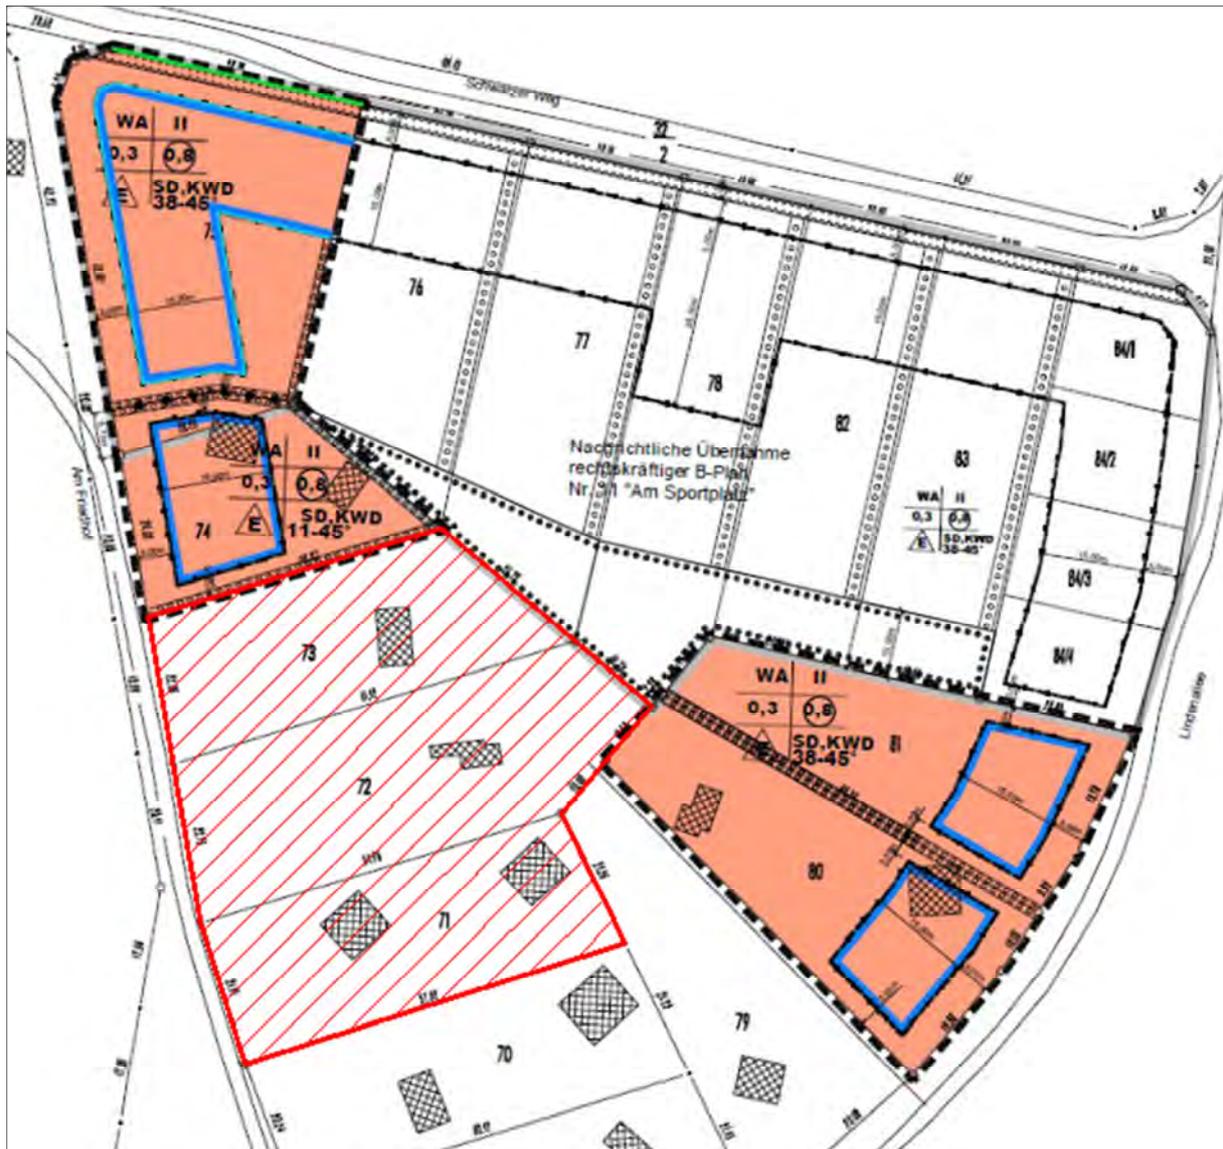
Lage des Plangebiets mit Darstellung des nördlich angrenzende Bebauungsplans Nr. 11 „Am Sportplatz“
